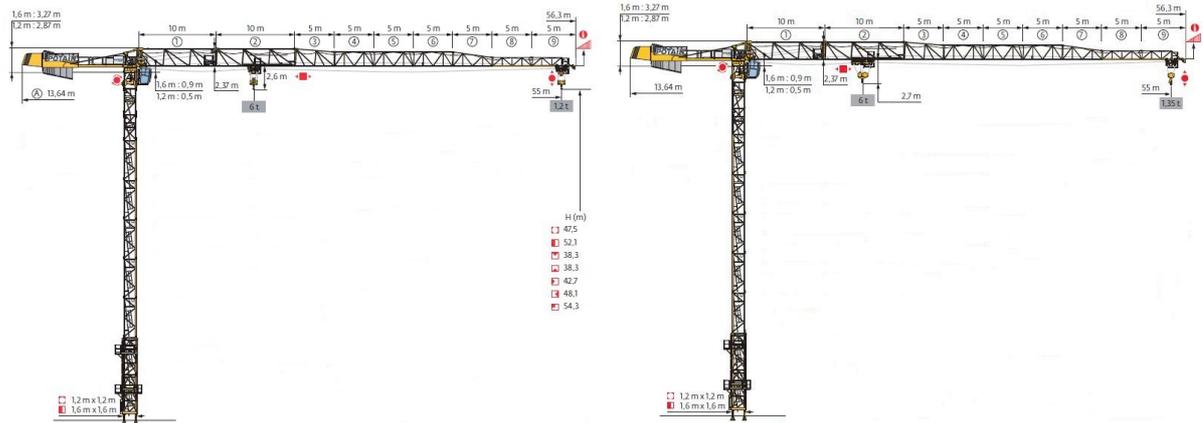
Potain Biegebalkenauslegerkran; links: MDT 98; rechts: MDT 109<sup>69,70</sup>
